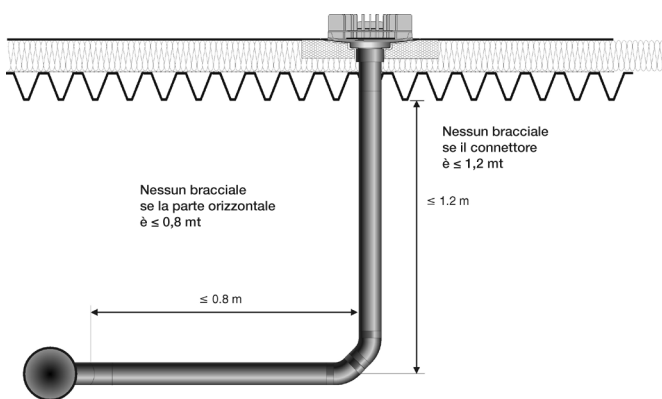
Nessun bracciale verticale se il tubo di scarico verticale $\leq 1,2$ metri.
